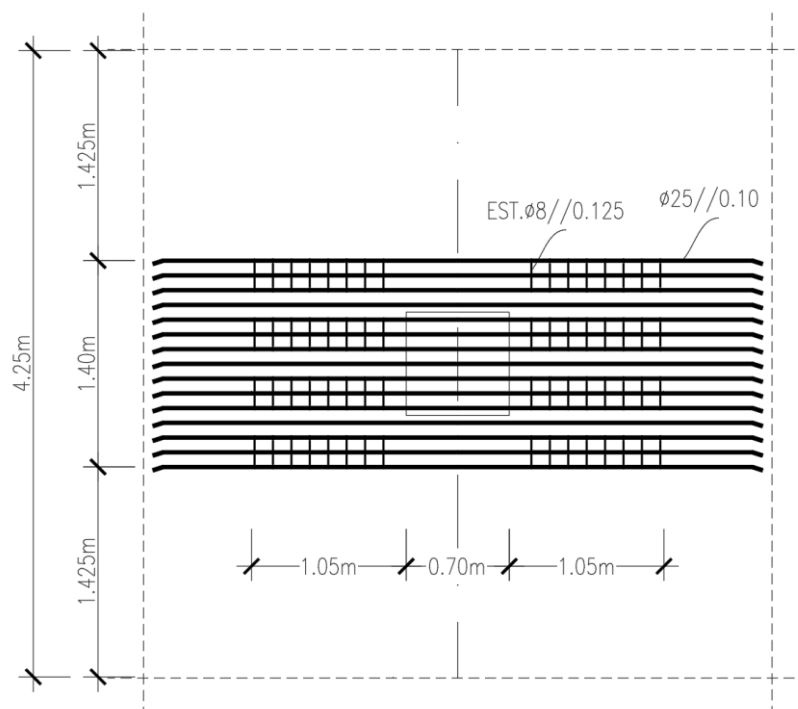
Pormenor das armaduras longitudinais e transversais, em planta, na direção X.
